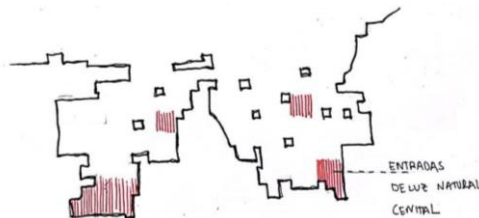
Planta del conjunto Ca'n Terra de Ensamble Studio. Boceto de elaboración propia.
